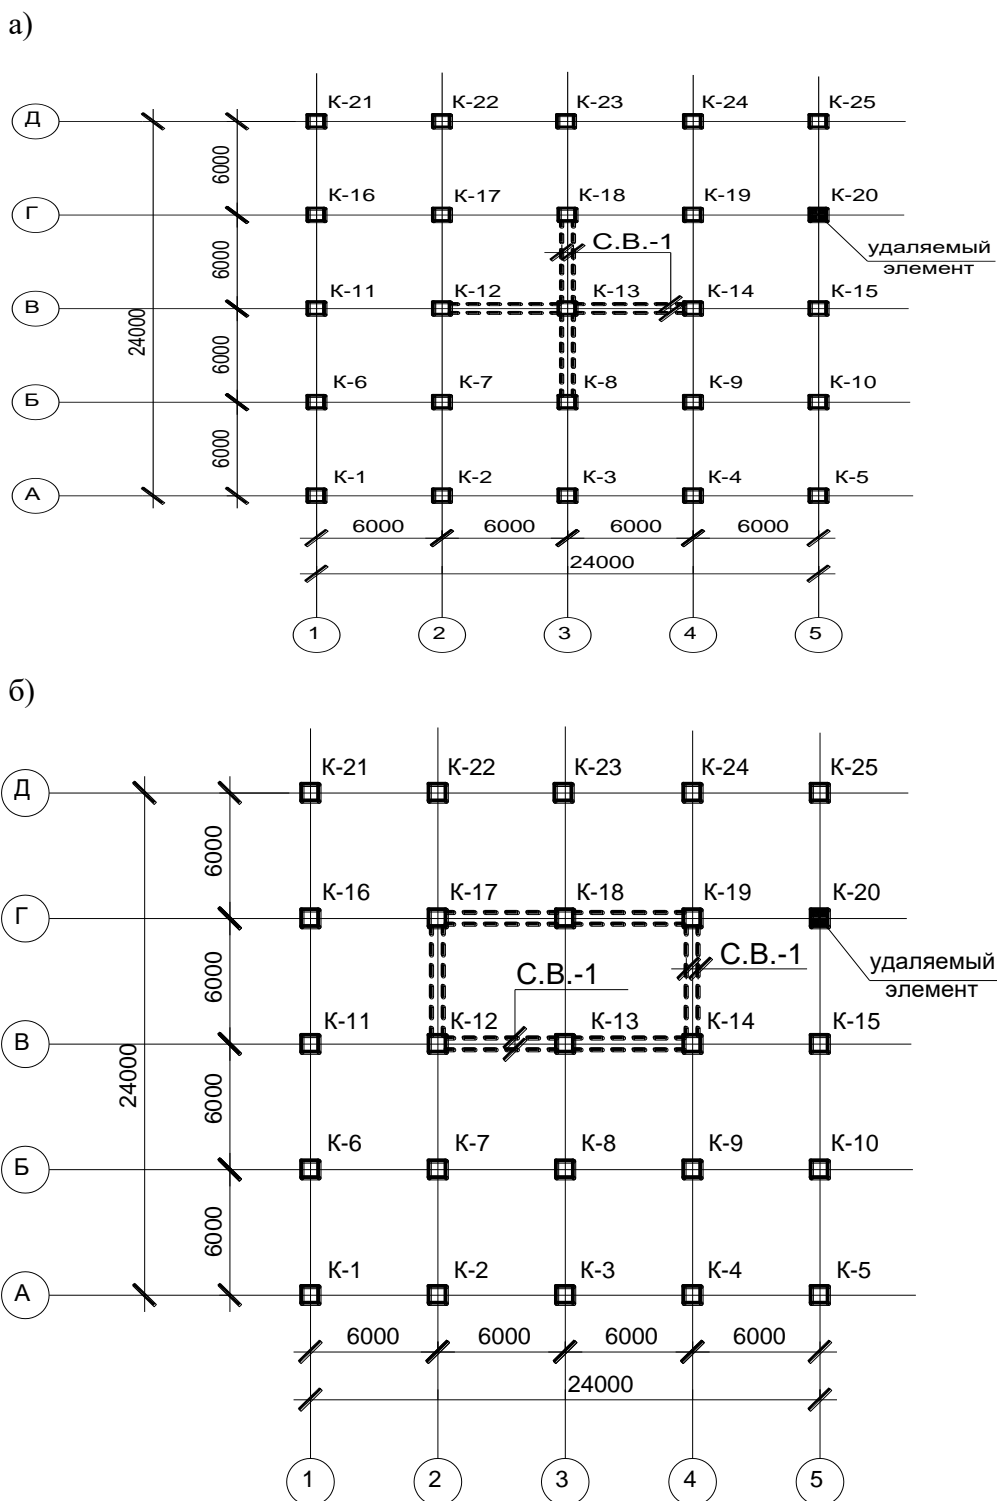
План двенадцатиэтажного безригельного каркасного здания с нумерацией колонн:
